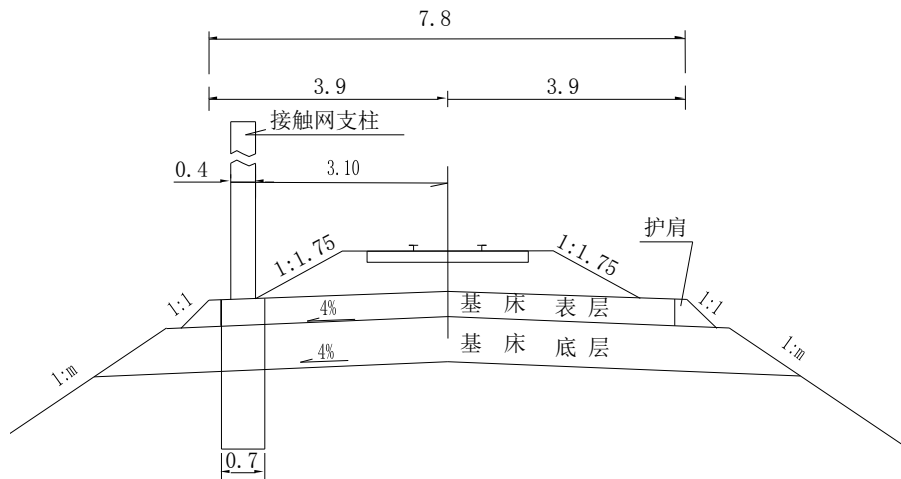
一般地段路堤标准横断面示意图 (m)
